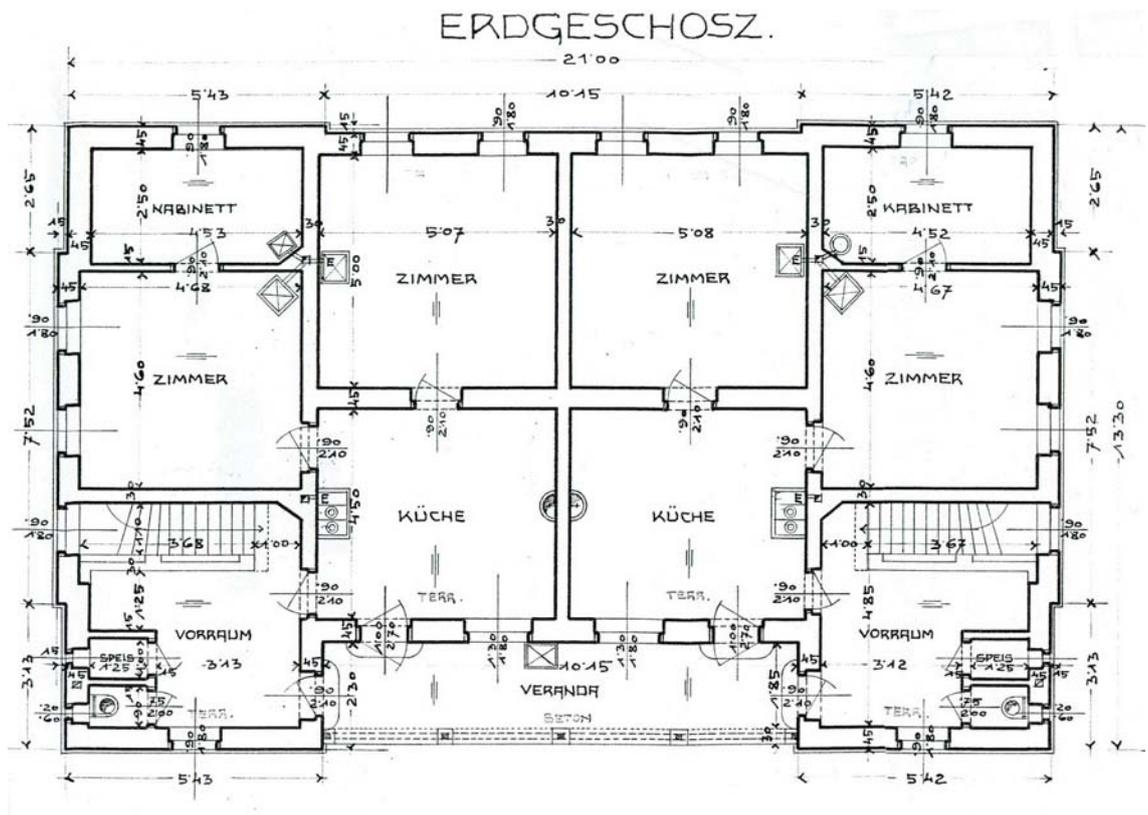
GRUNDRISS EINES PFLEGERDORFGEBÄUDES
